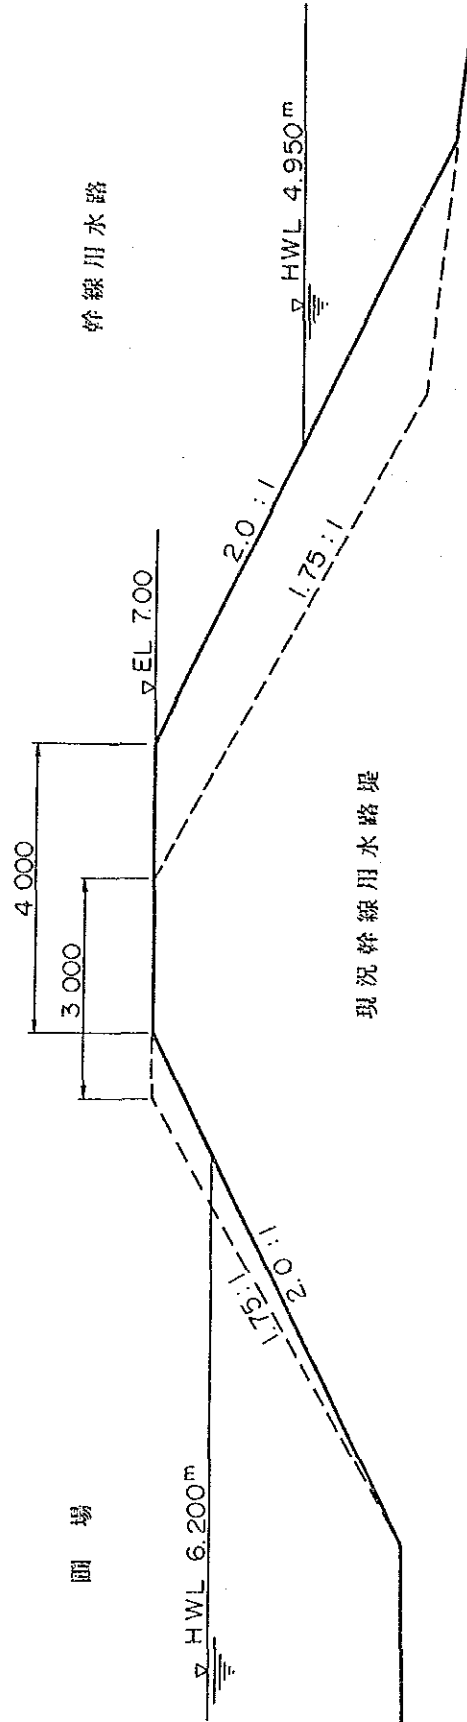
4 - 13 幹線用水路堤の計画標準断面図
